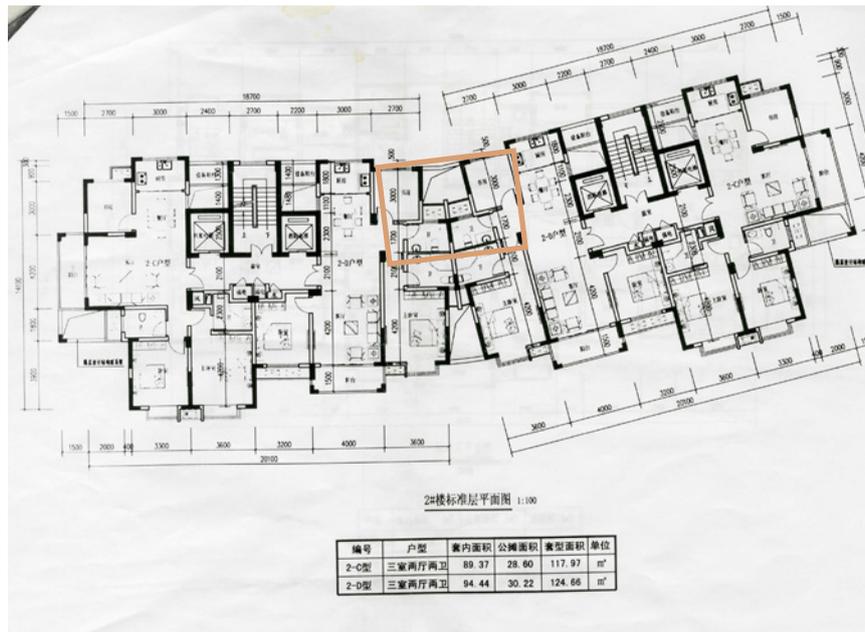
Bsp.3: gespiegelter Grundriss
